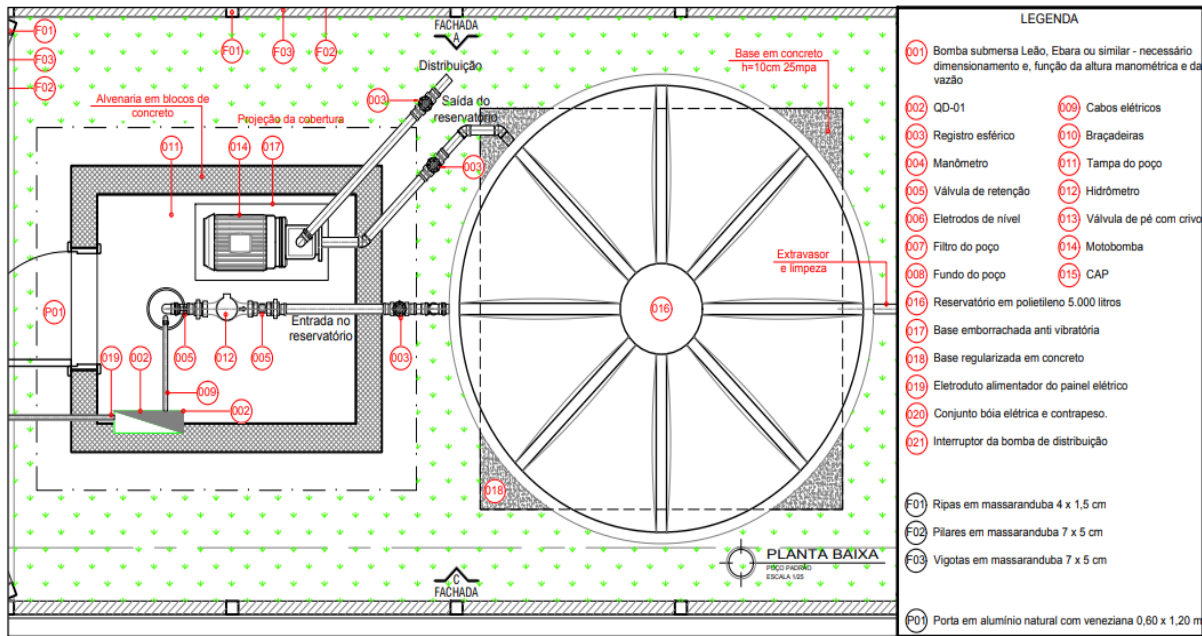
Planta baixa com detalhamentos do projeto executivo de captação de água subterrânea. Fonte: Acervo CMA (2019).
